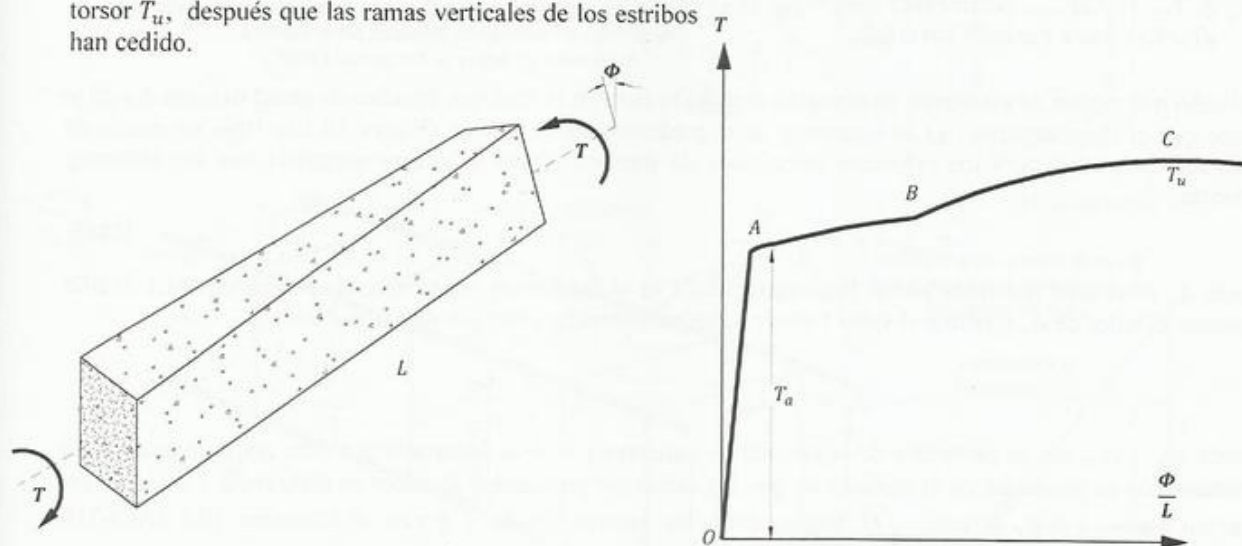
Comportamiento de una viga de concreto armado sometida a un par torsor
